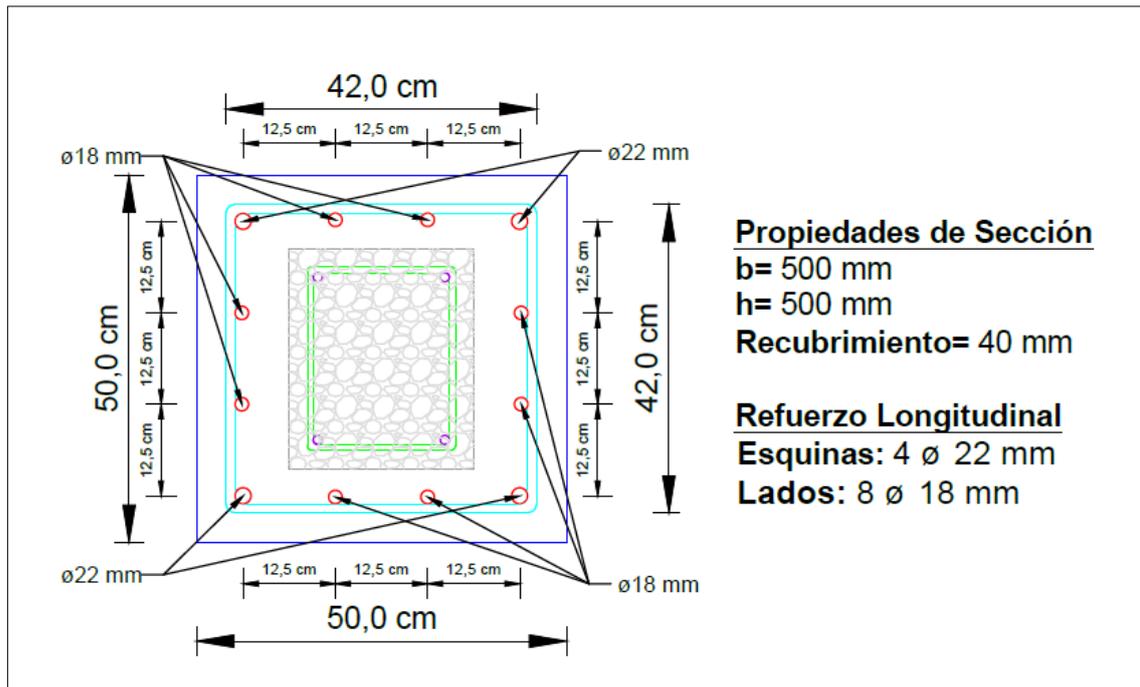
Columna central del Piso 1: Armado para encamisado.
